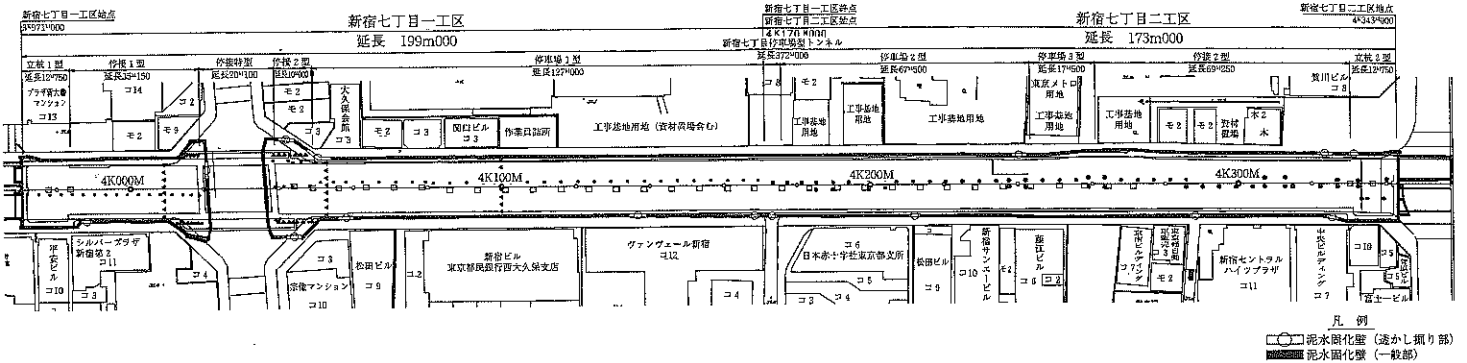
13号線新宿七丁目駅(仮称)杭打ち平面図
